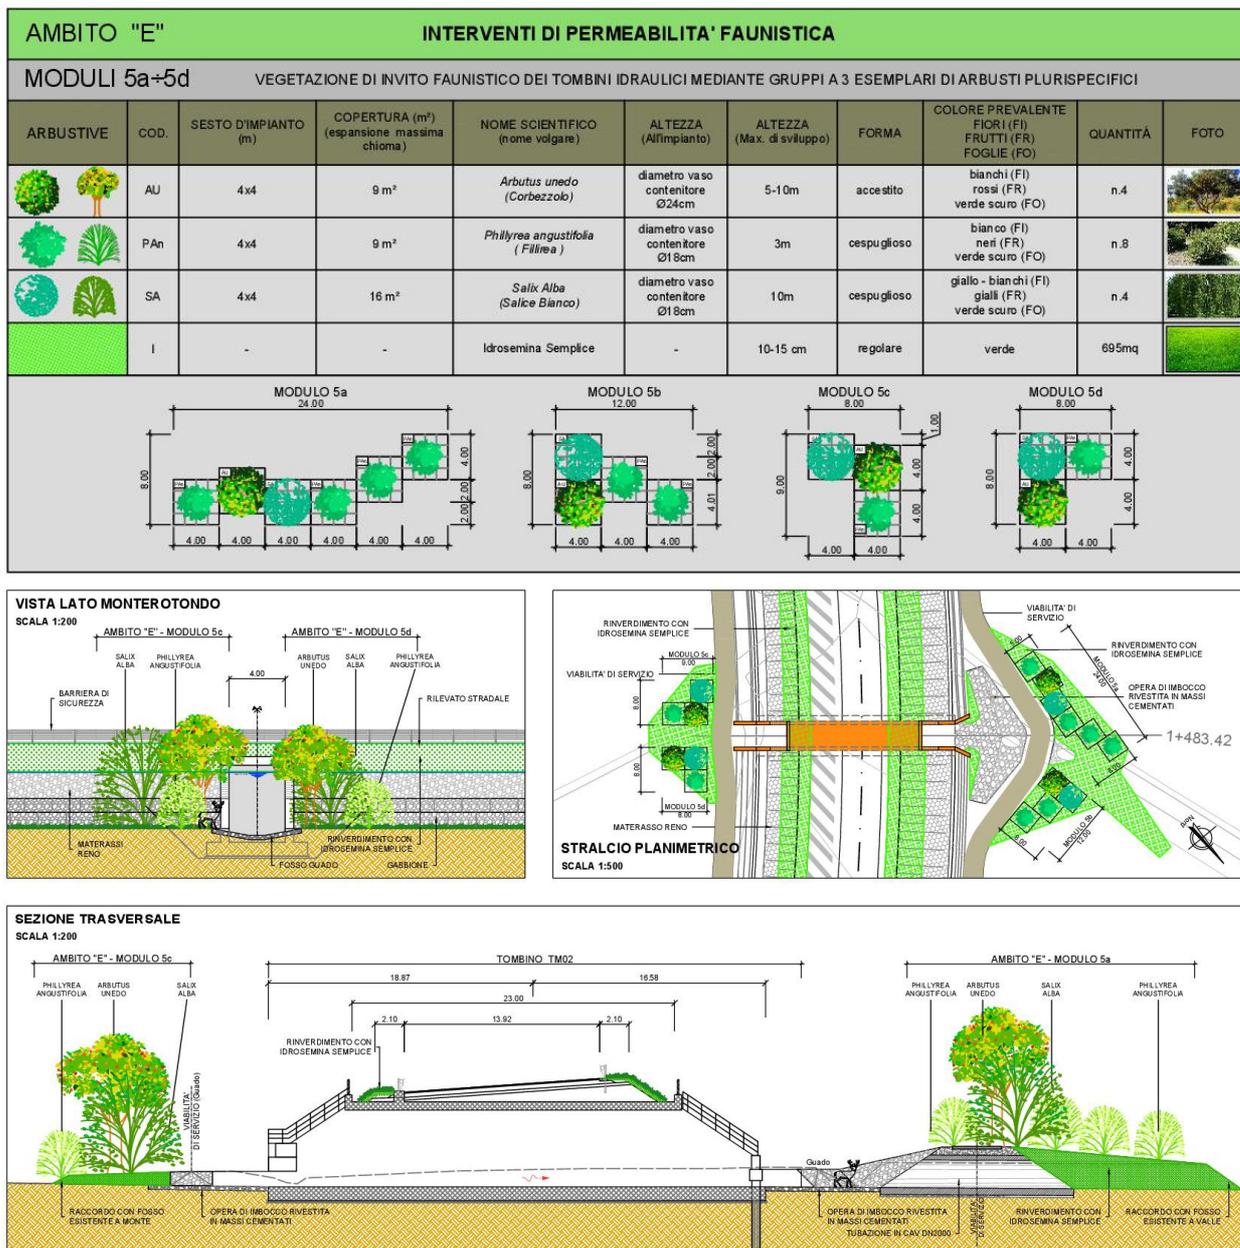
Stralcio planimetrico e sezione - Ambito E, Moduli 5a-d – Passaggi faunistici
